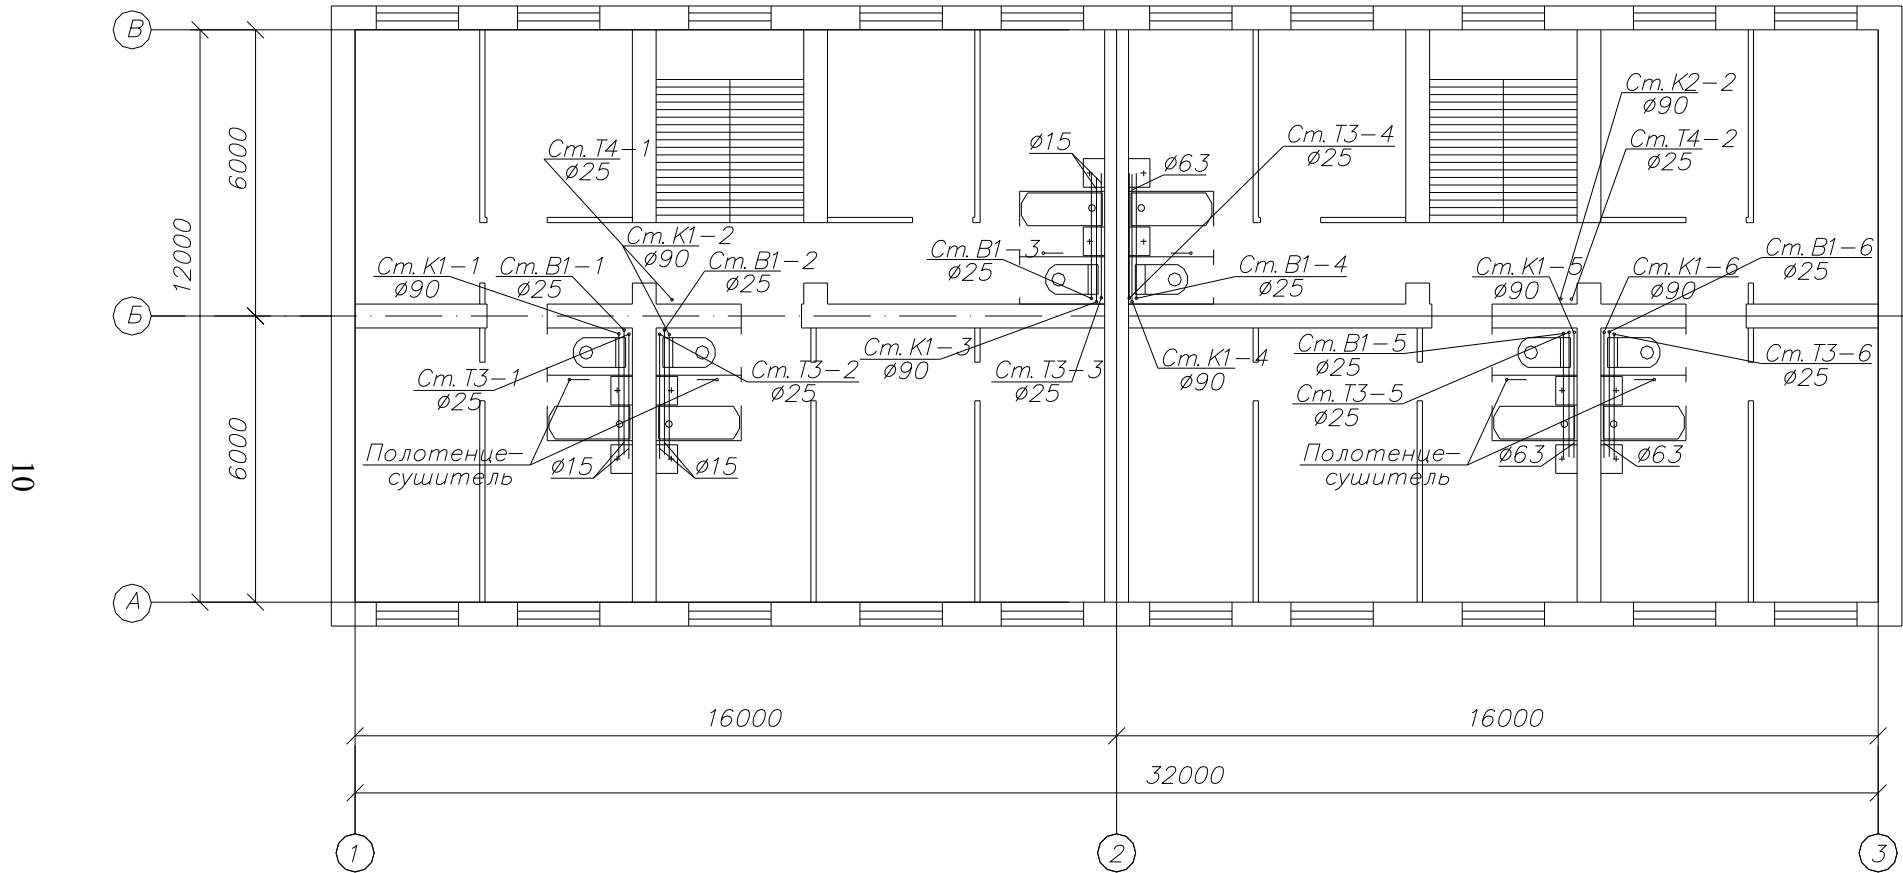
Трассировка трубопроводов на планах здания: типовой этаж
